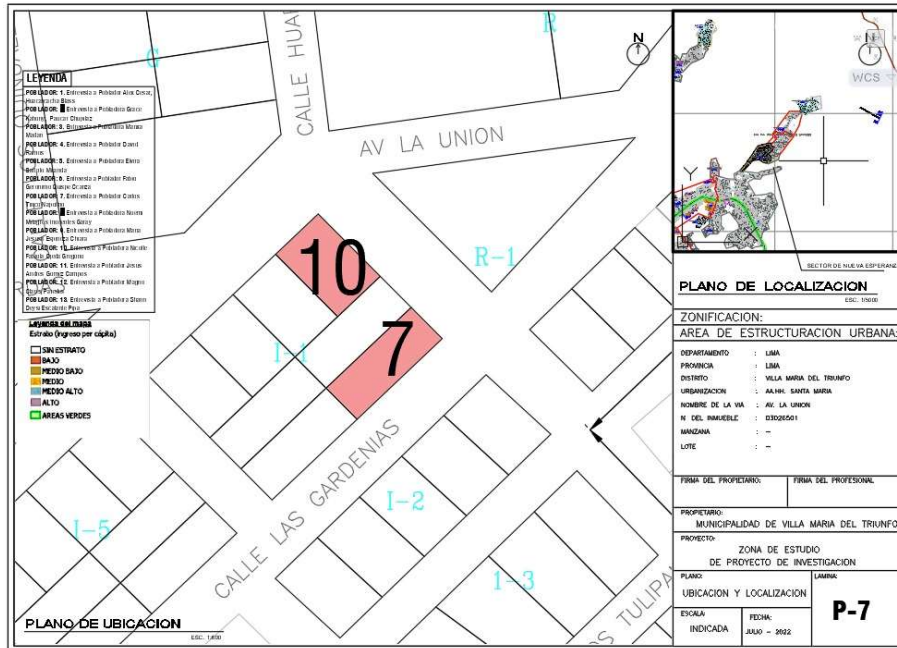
Plano de Ubicación de Casa del Señor Fabio Geronimo Quispe Ccanza
